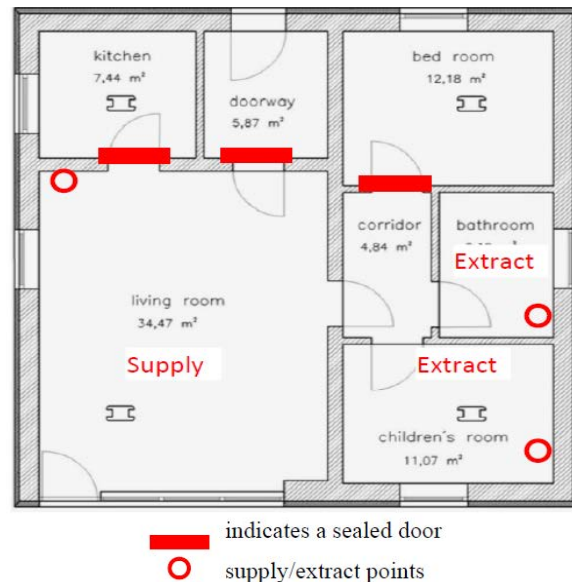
Grundrissplan des Erdgeschosses inklusive Lüftungskonzept.
